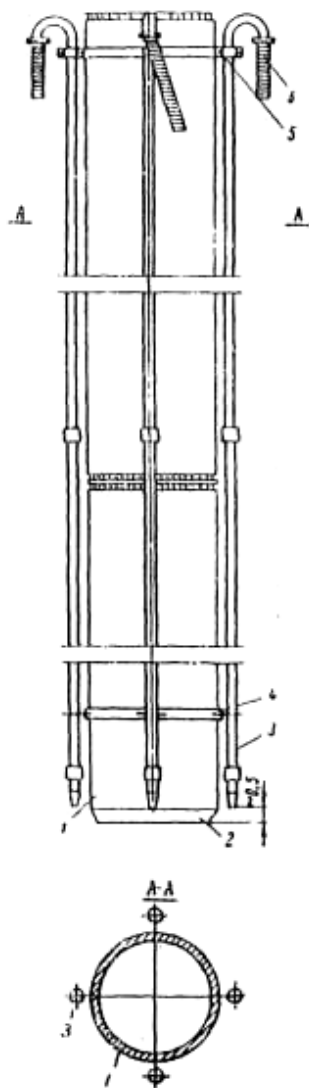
Схема прикрепления подмывных трубок к вертикальной оболочке: 1 - оболочка; 2 - нож; 3 - подмывные трубки; 4 - направляющий хомут; 5 - удерживающий хомут; 6 - резиновый шланг.
